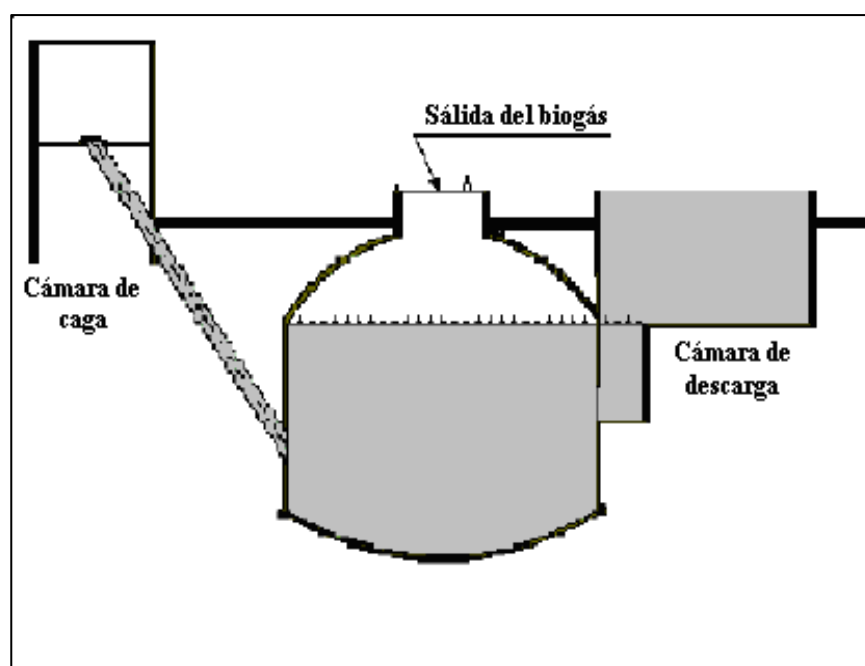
Biodigestor Planta de Domo Fijo²⁷
